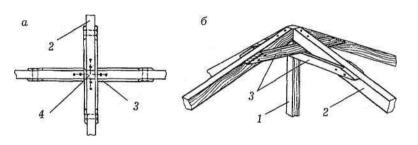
Несущая конструкция для четырехскатной крыши: a-вид сверху; b-общий вид: b-бабка; b-стропильная нога; b-д-ригель
